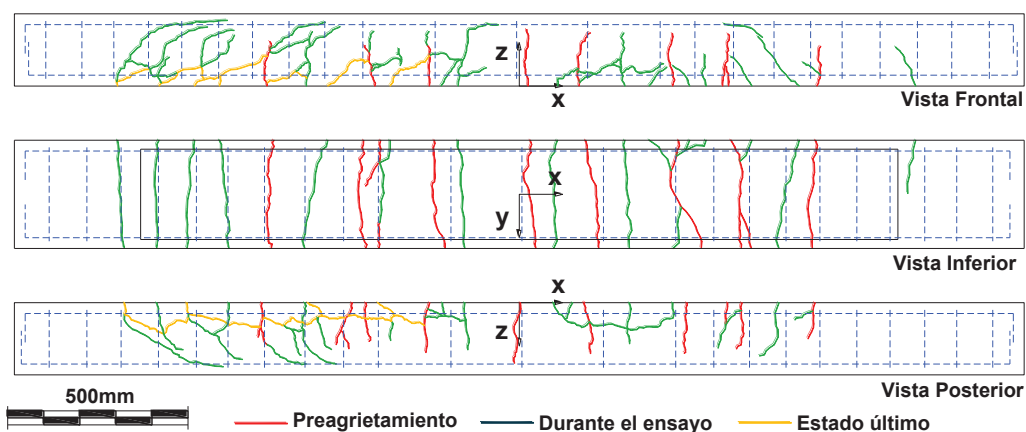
Esquema del patrón de agrietamiento de la viga 3A durante el ensayo por carga última.
